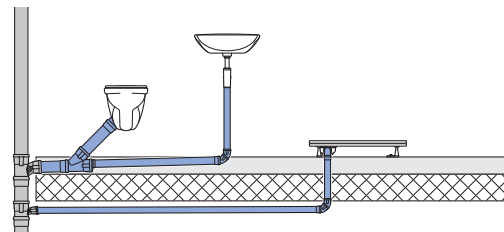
Ausführung mit Sammelanschlussleitungen im Fußbodenaufbau und Einzelanschlussleitung unter der Decke
